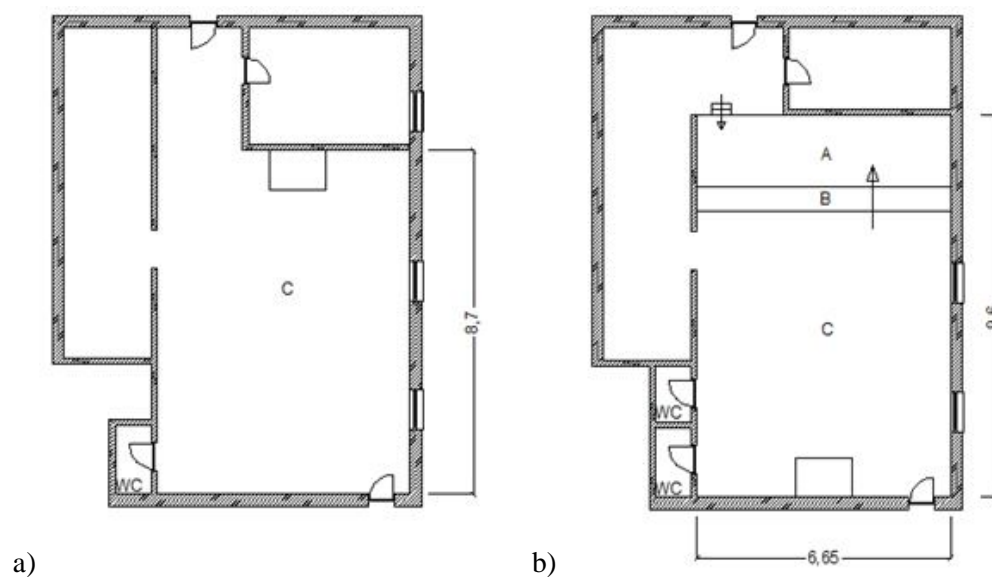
3 - Planta da sala de ensaio da B.M.M.P. antes (a) e depois da reabilitação (b) [Planta do autor].
